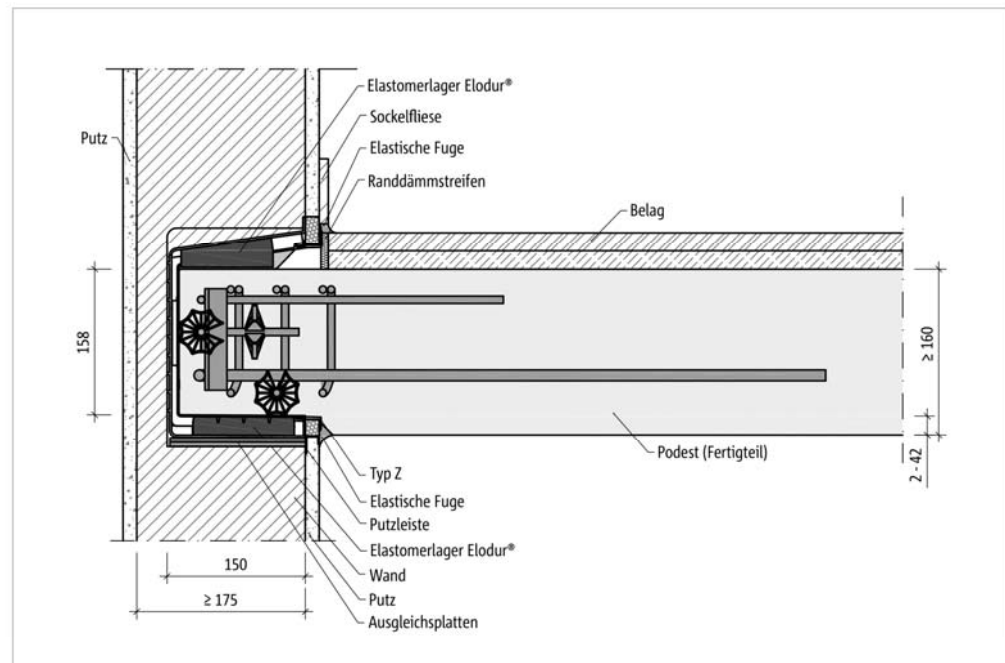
Schöck Tronsole® Typ Z-V+V-T: Einbauschnitt Fertigteilpodest
